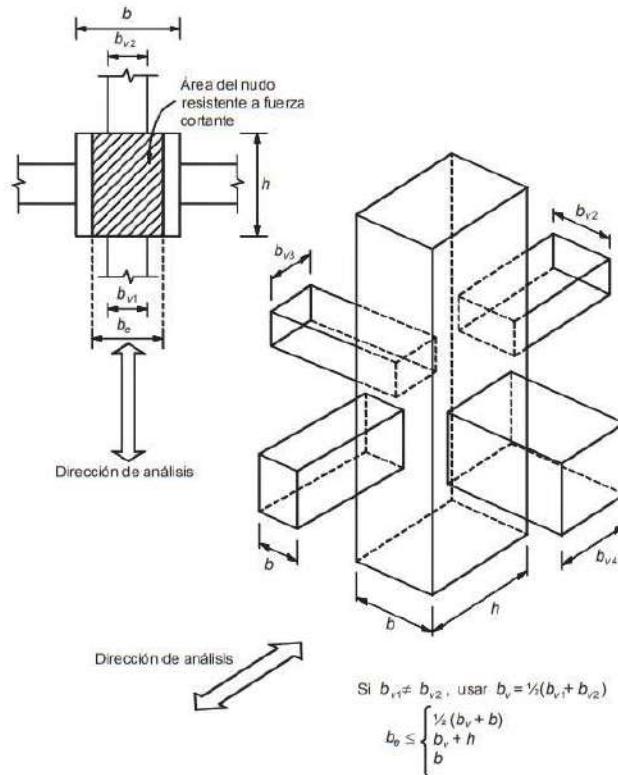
Área de la sección que resiste la fuerza cortante en nudos de estructuras de ductilidad alta.
